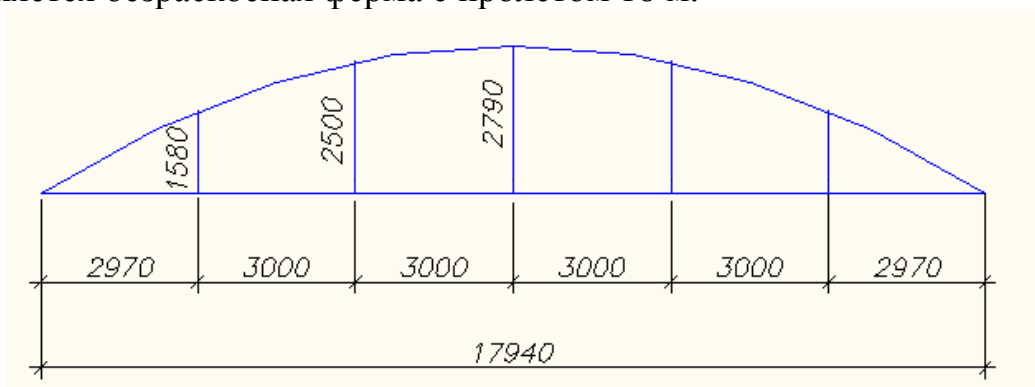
Геометрическая схема безраскосной фермы пролетом 18 м
